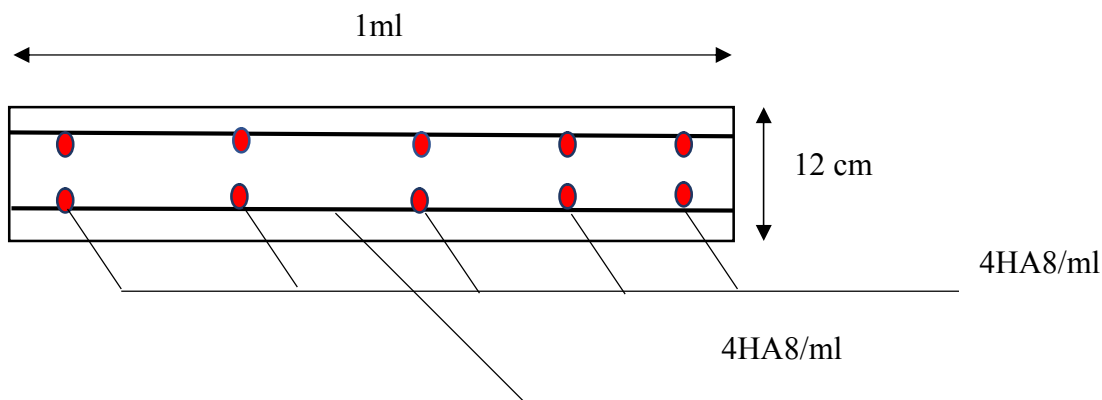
Schéma de ferrailage de la dalle sur trois appuis.
